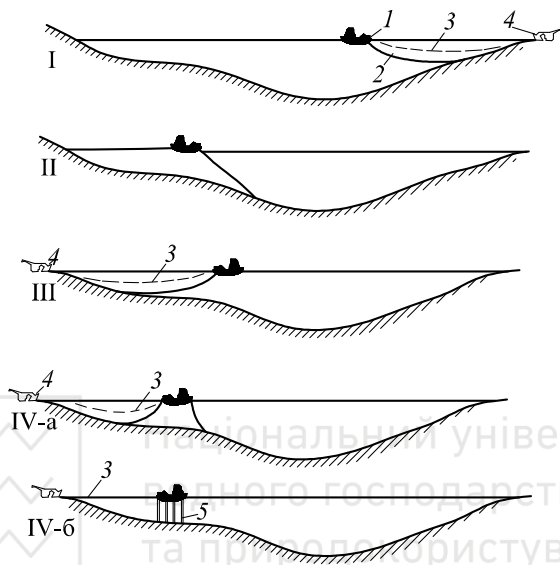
Схема прокладки підводного трубопроводу на переході з використанням трубоукладочної баржі:
